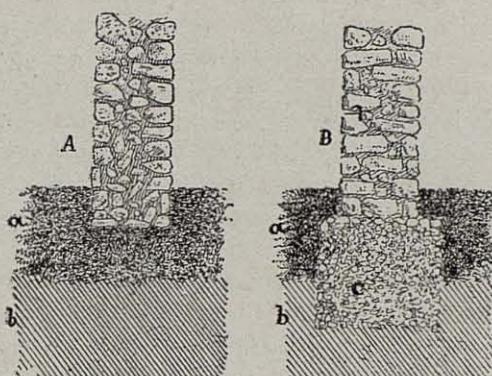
ª—A, muro con cimientos mal construidos.—B, fundación y muro bien construidos.—a, tierra vegetal; b, terreno firme; c, cimiento.
